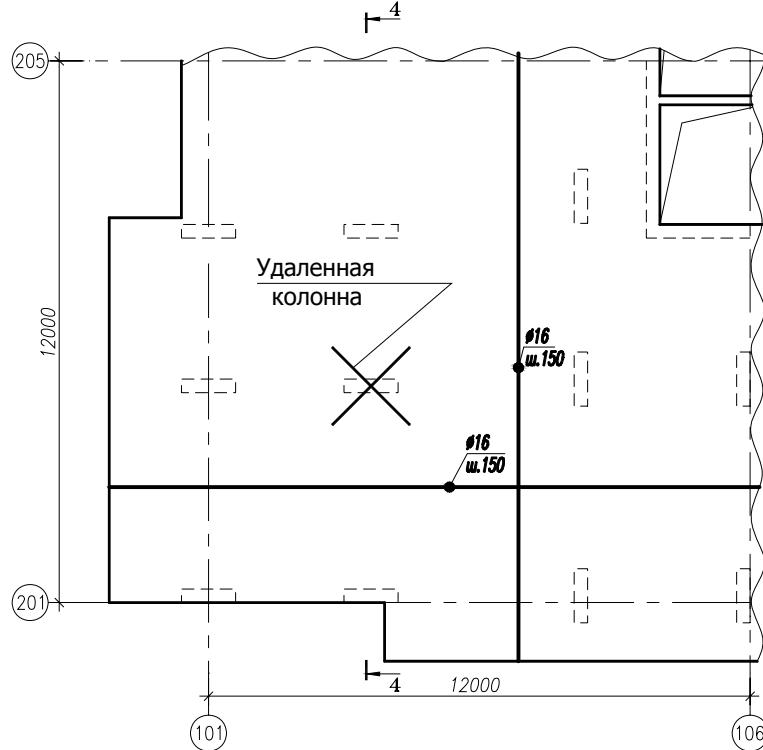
Фрагмент нижнего армирования плиты перекрытия
